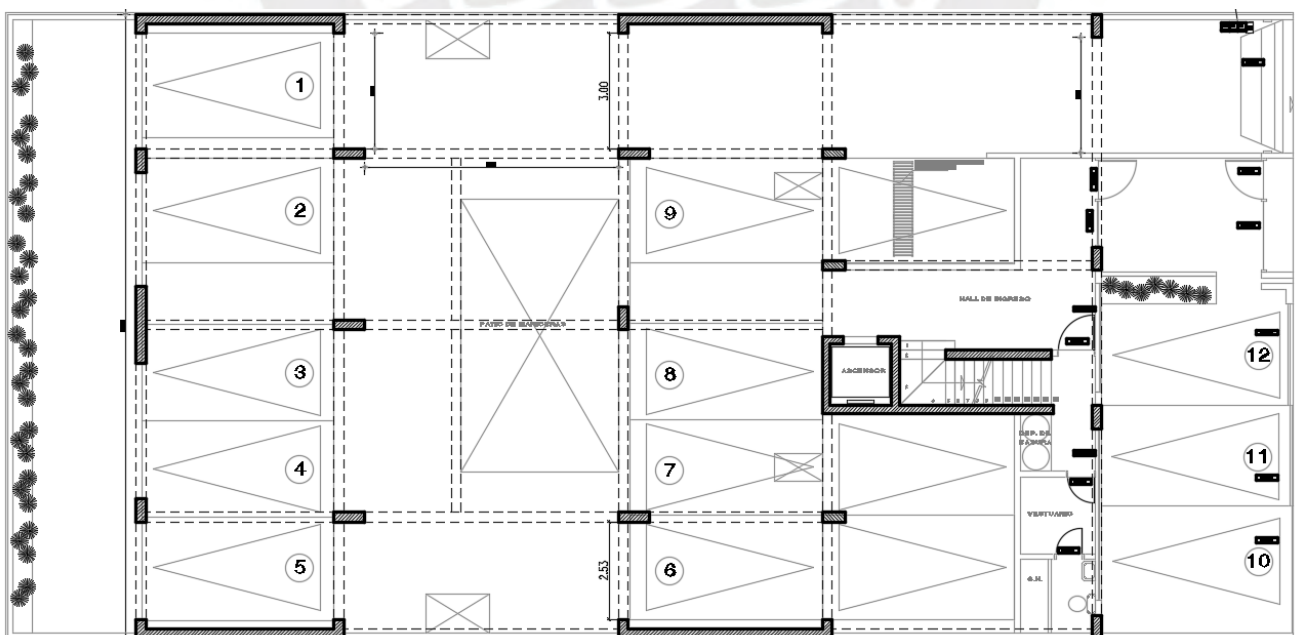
Ubicación de los elementos estructurales en la planta del edificio
